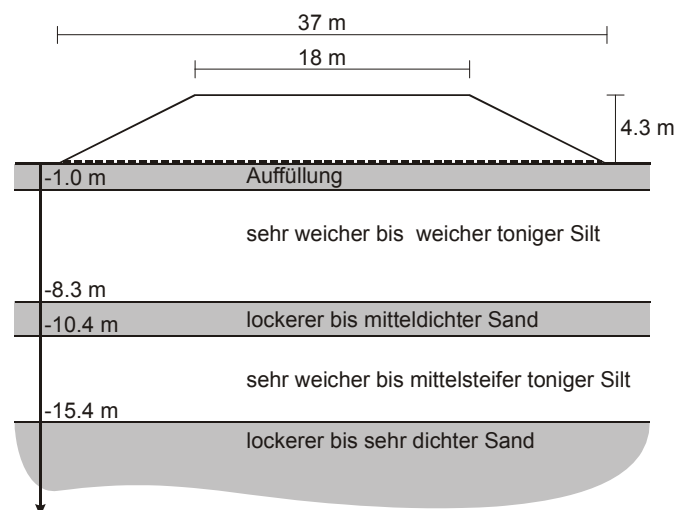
Querschnitt des Damms mit Bodenaufbau [47]
